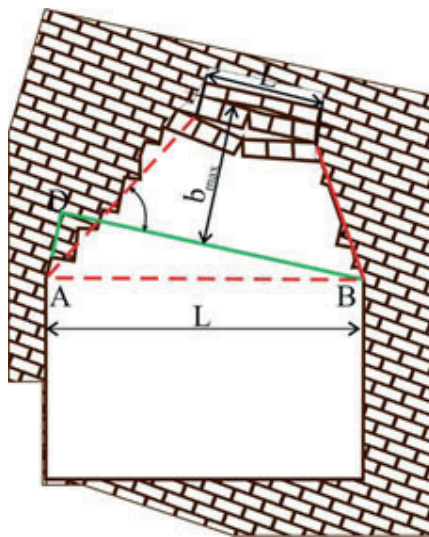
Схема разрушения трещиноватых пород в кровле выработки
